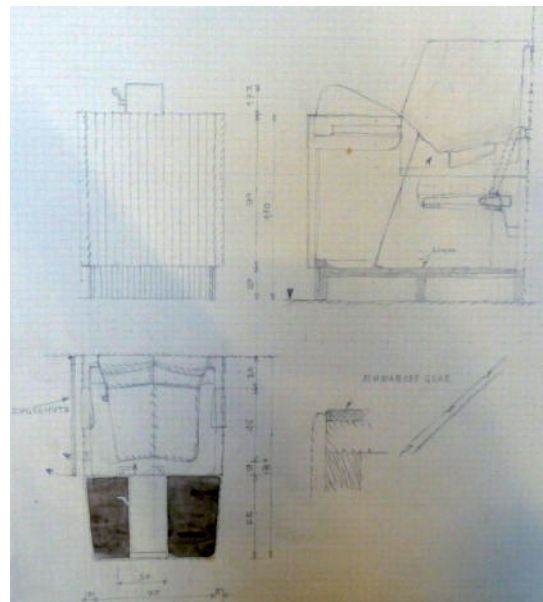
(oben): *Arabia am Kohlmarkt*, Sitzkassa im Essensoraum, Grundriss, Schnitt und Ansicht, kolorierte Entwurfszeichnung, Oswald Haerdthl, 1950.
